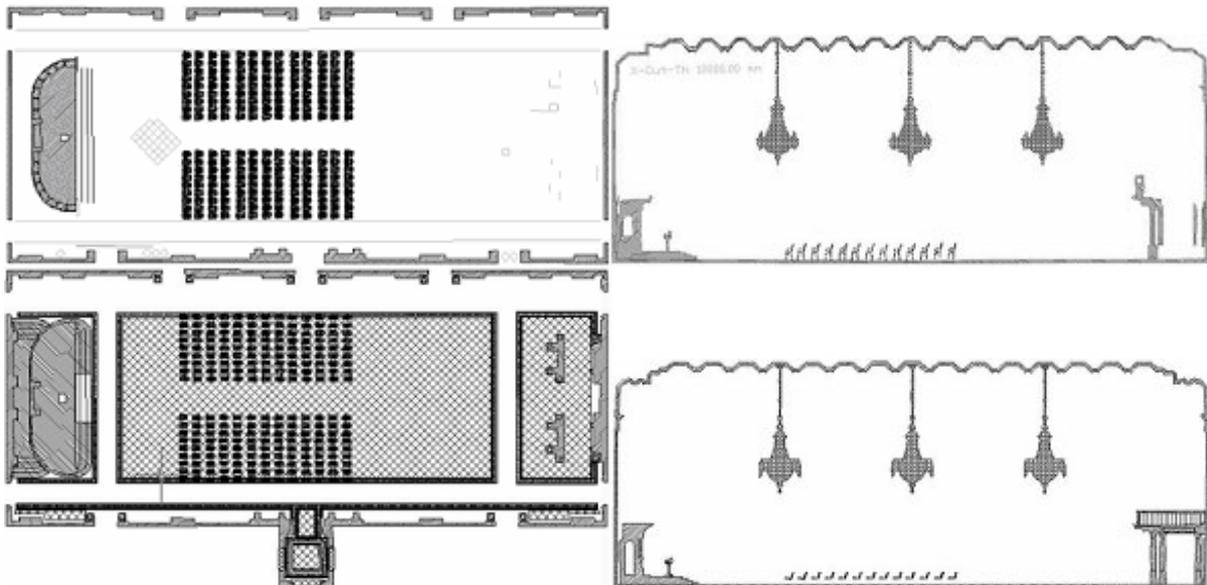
Detaillierungsgrad der 3D Pläne (Grundriss und Längsschnitt) des großen Festsaales aus den Daten des GS100 (oben) und des IMAGER 5003 (unten) konstruiert.
